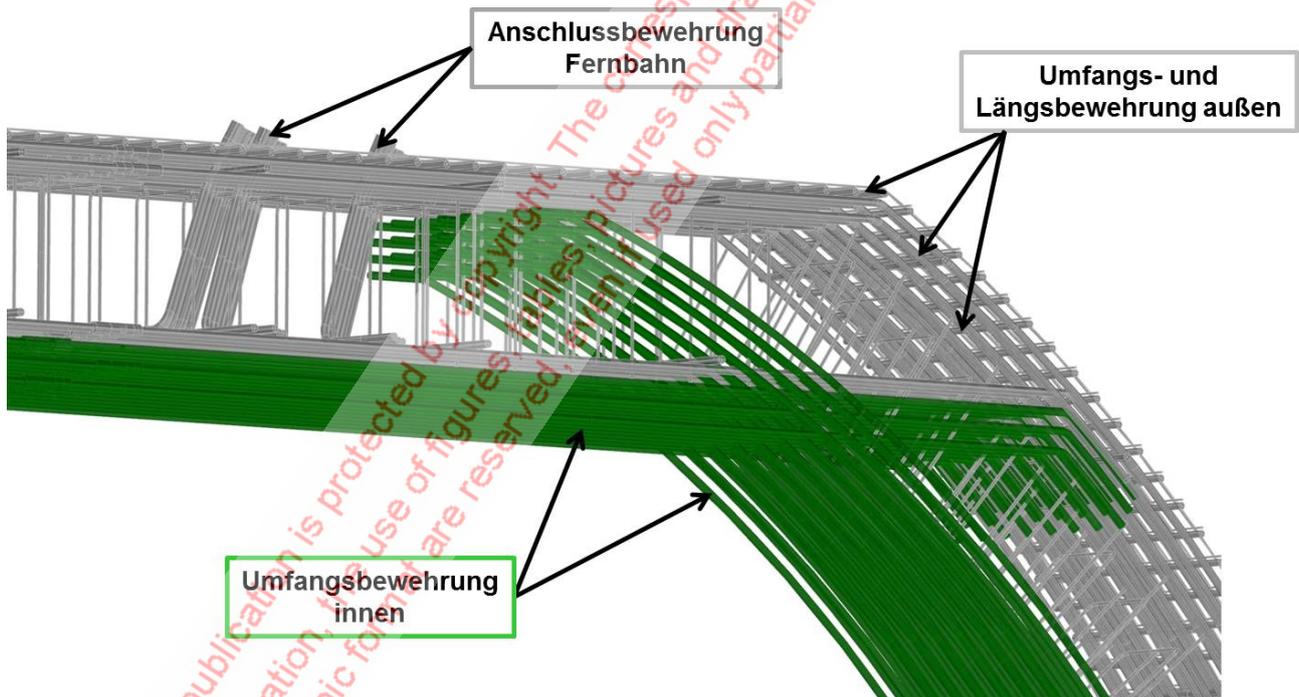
Bewehrung Rahmenecke S-Bahn-Tunnel, räumliche Darstellung
